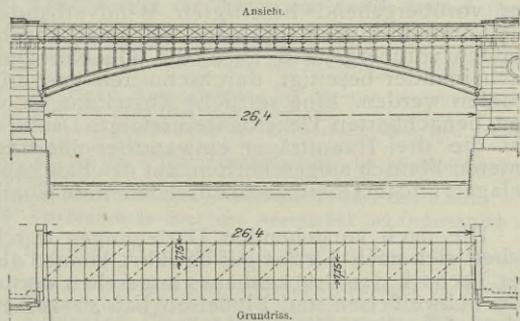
Stadtbahnbrücke am Kupfergraben in Berlin.
